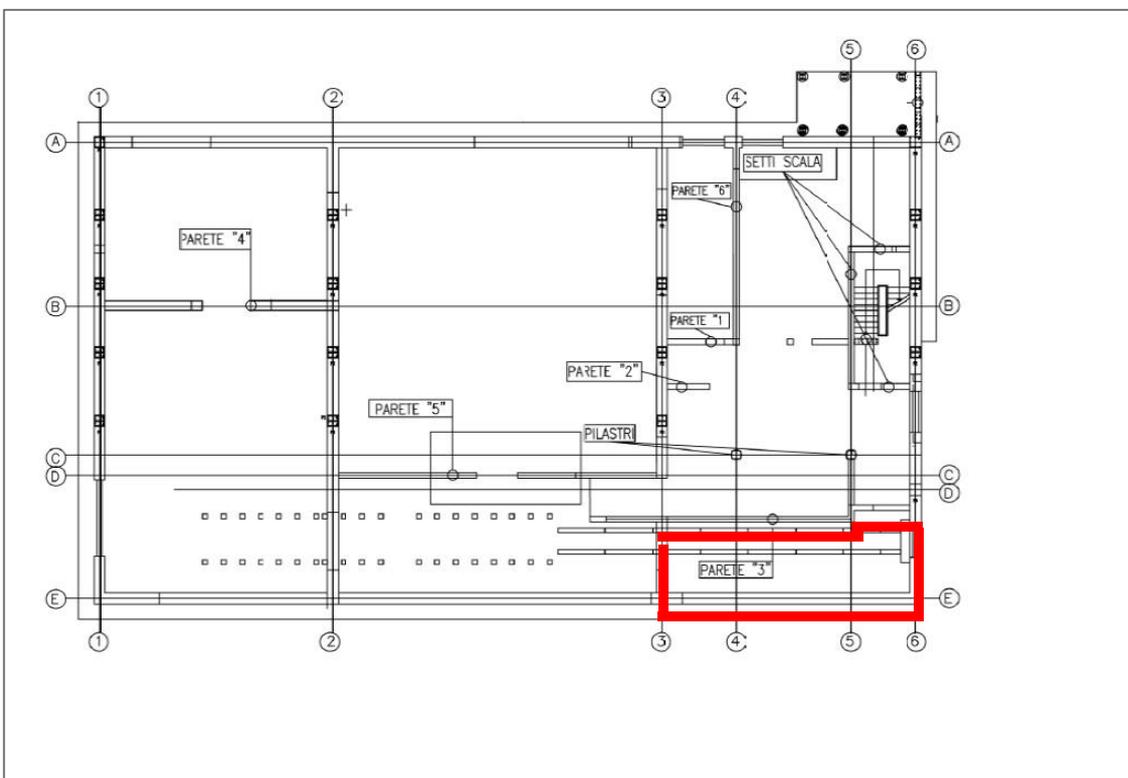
Planimetria di progetto con indicazione (in rosso) delle strutture in elevazione ad oggi realizzate
